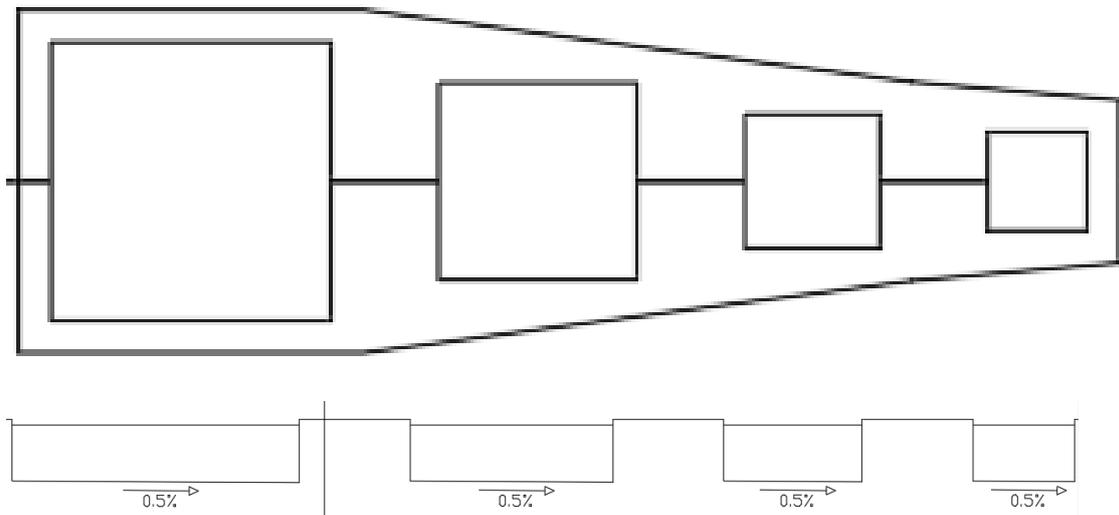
Detalle planta y alzado de lagunas anaerobias Fuente: edición propia
